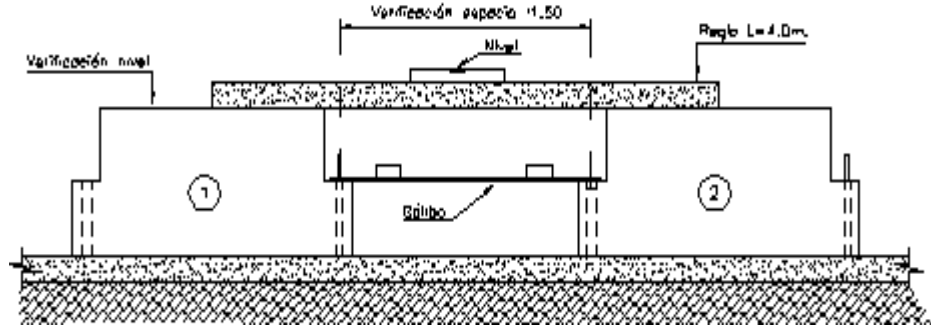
COLOCACIÓN DE LA SOLERA
